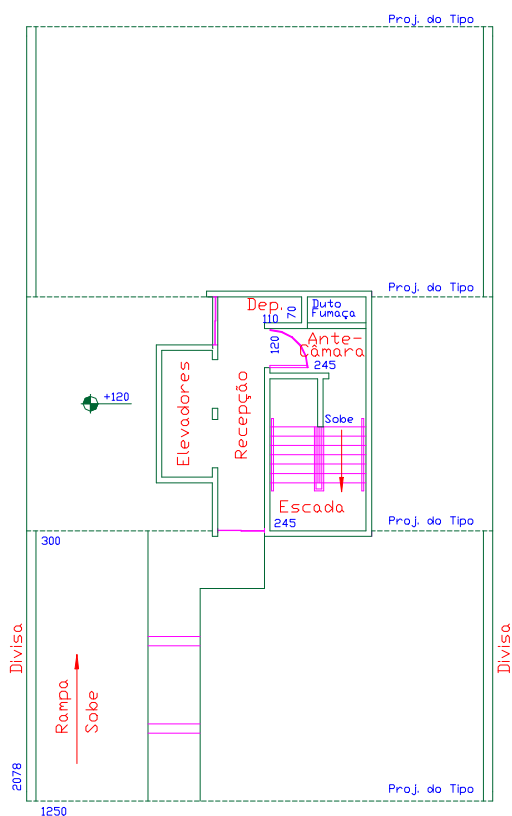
Edifício Exemplo: Planta Baixa Têrreo
